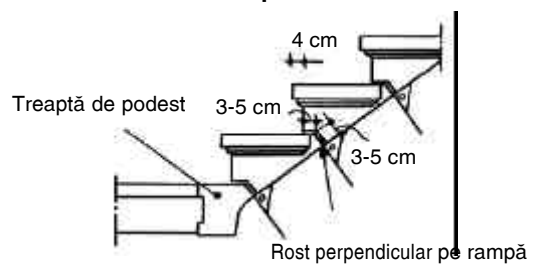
Elemente componente scări. Balustrade, parapete. Mână curentă (I). Scări exterioare (II.)
